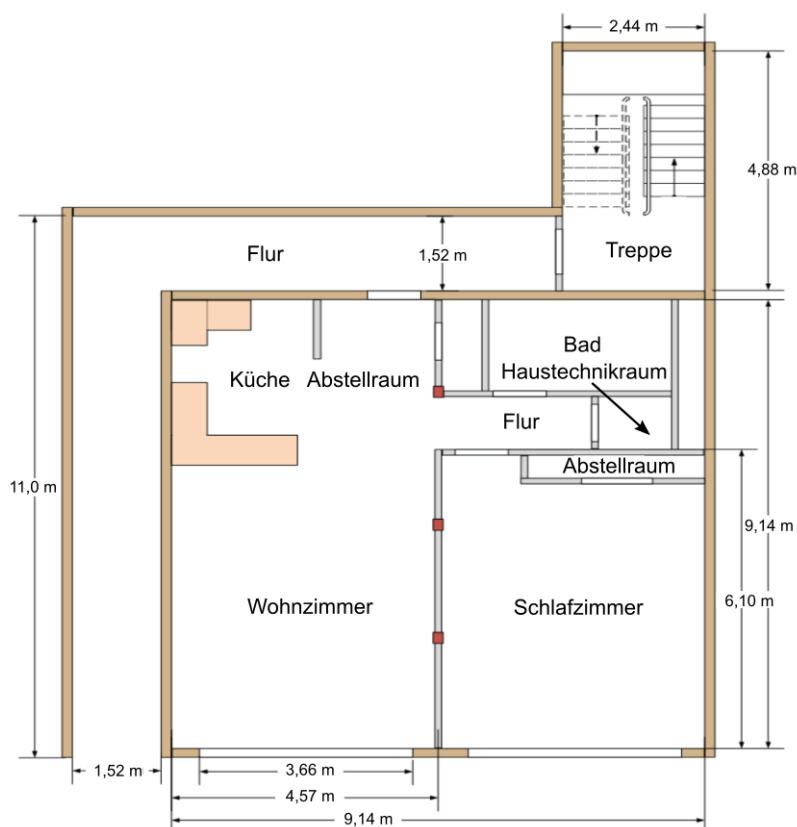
Grundriss des Versuchsraums von Test 3 (eigene Darstellung nach Zelinka [11])
